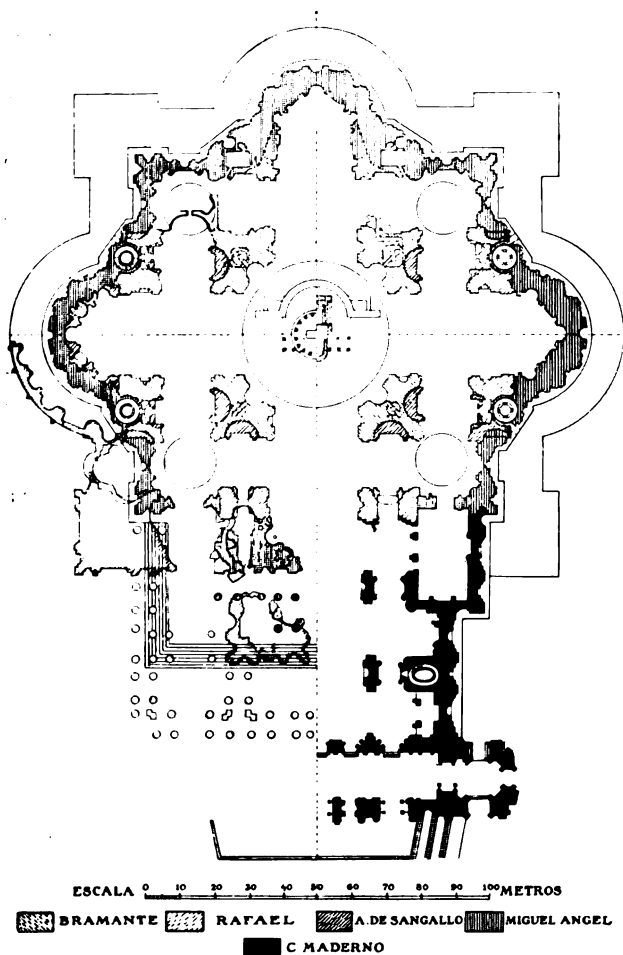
Planta de San Pedro del Vaticano, con las sucesivas modificaciones del conjunto.
